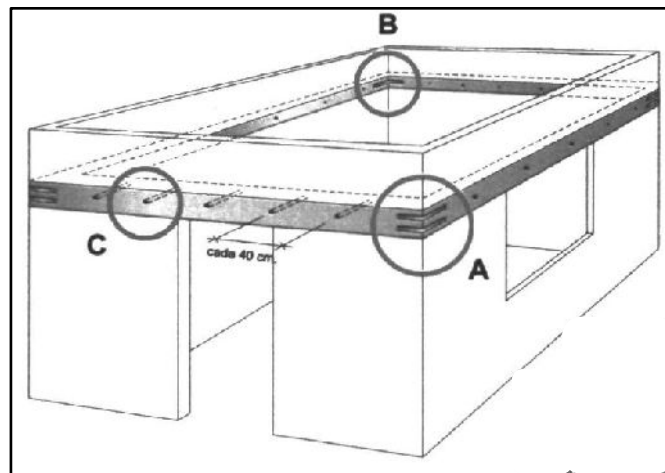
Viga Collar CSK de madera y uniones metálicas (Kuroiwa, 2002)
